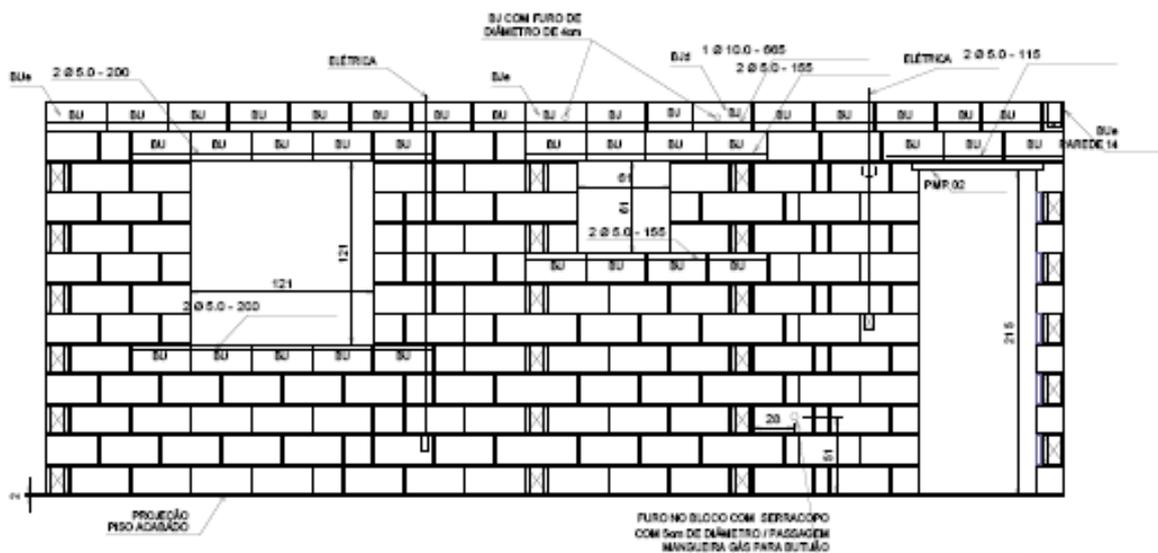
Planta da elevação da alvenaria (ABCP, 2002)
